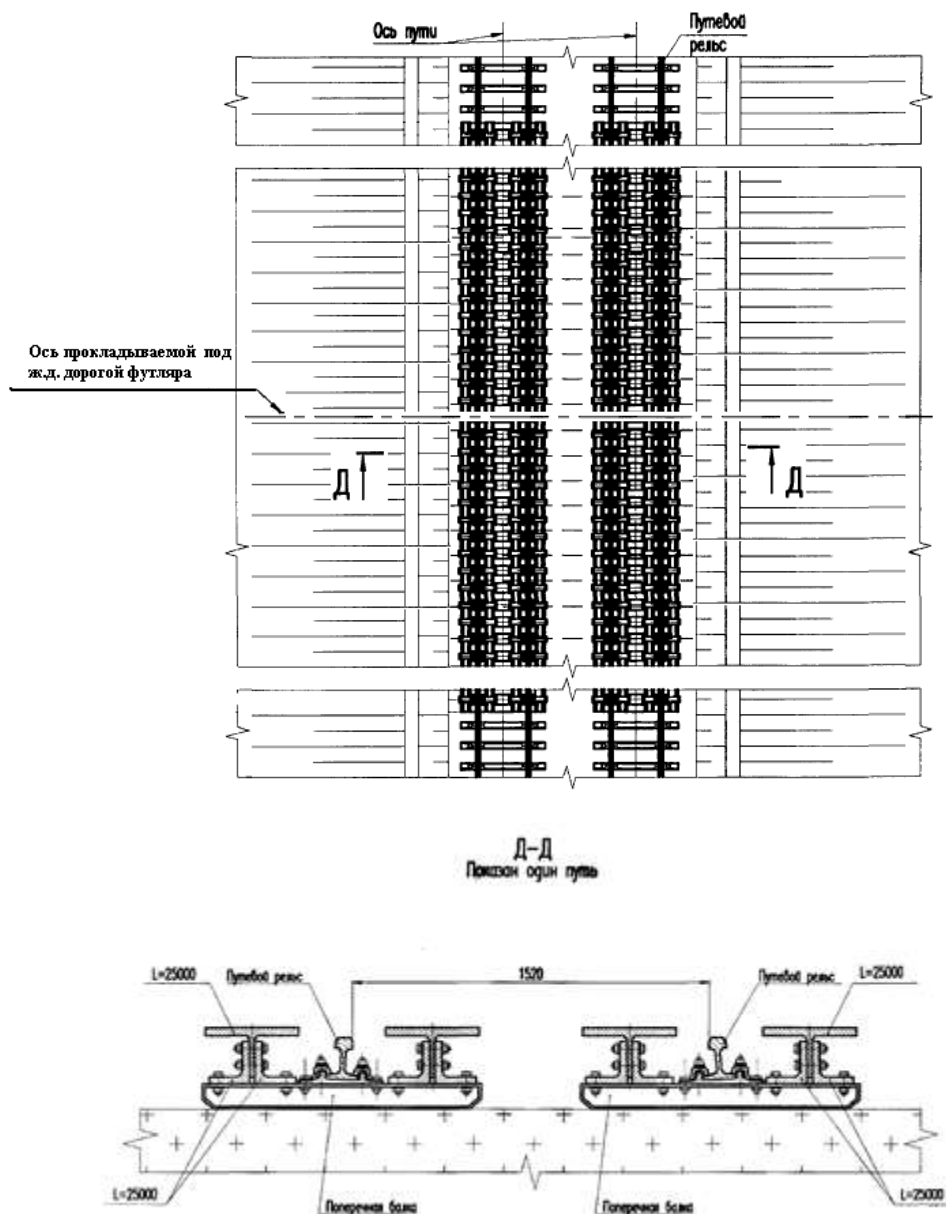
План установки и разрез рельсового пути с установленными страховочными пакетами
